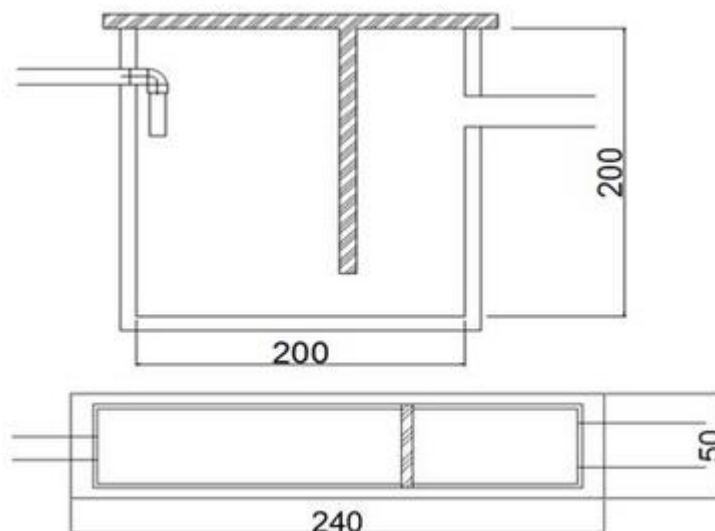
Dimensões da caixa de gordura (vista lateral e planta baixa, respectivamente).
